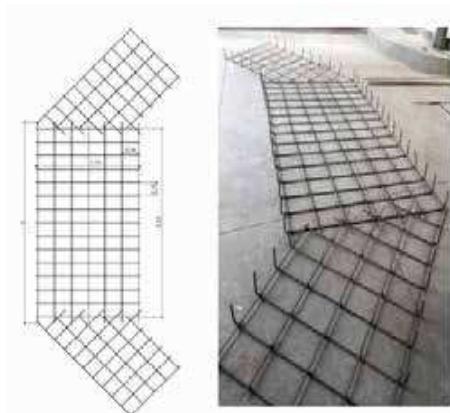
Parte de la armadura planificada y la armada en taller. Para cimentación de estribos.
